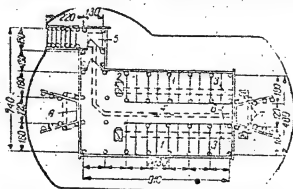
Ziemianka z dachem jednostronnie pochylonym typu zagłębionego na 15 ludzi. Plan i przekrój poprzeczny:
